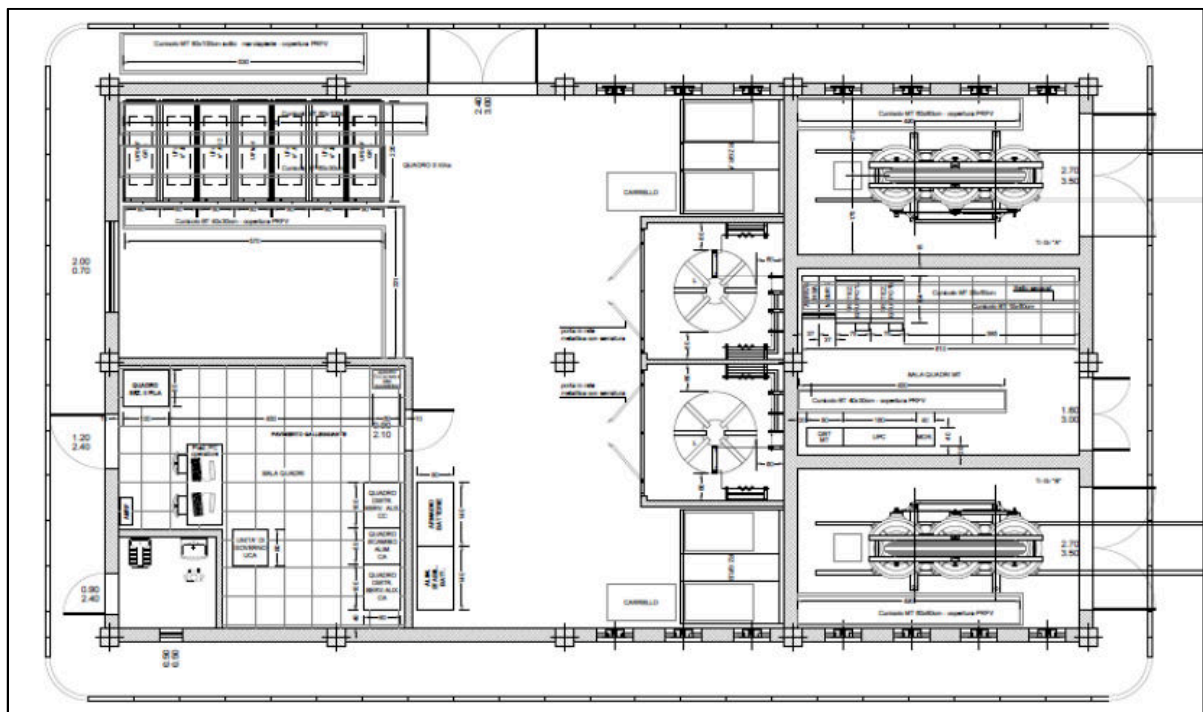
Layout Fabbricato SSE (Fonte: All. 1 alla Lista di Controllo *Relazione generale*)
